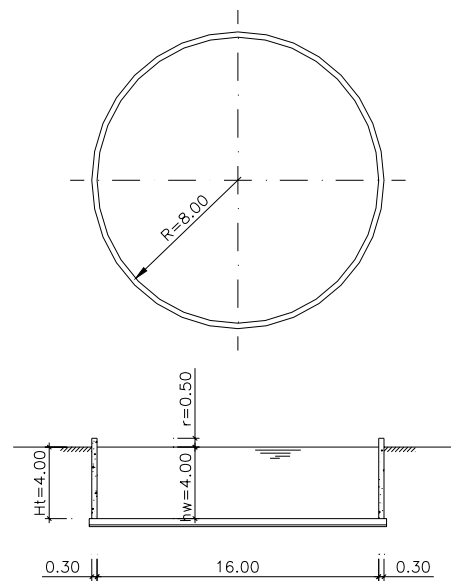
Cálculo de la pared de un depósito cilíndrico de hormigón armado
